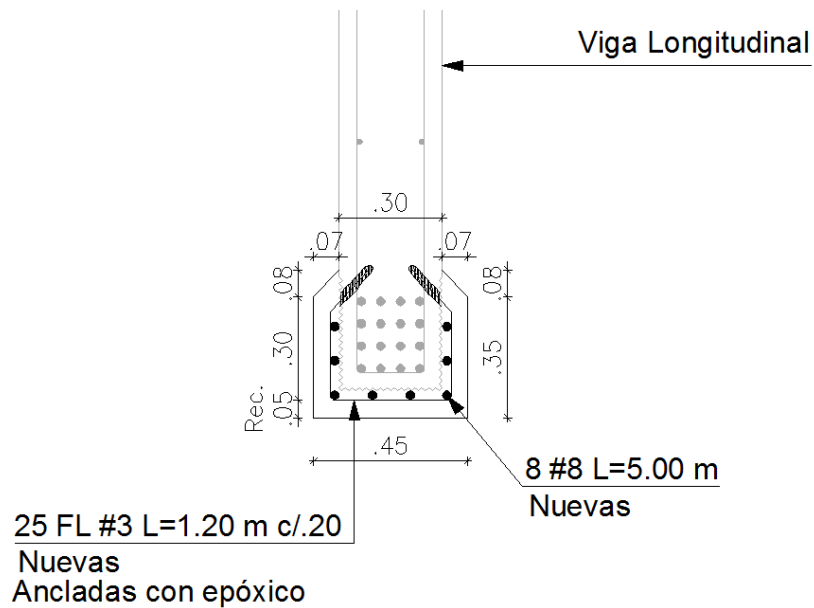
Distribución del refuerzo longitudinal de reforzamiento en el centro de la luz de las vigas
